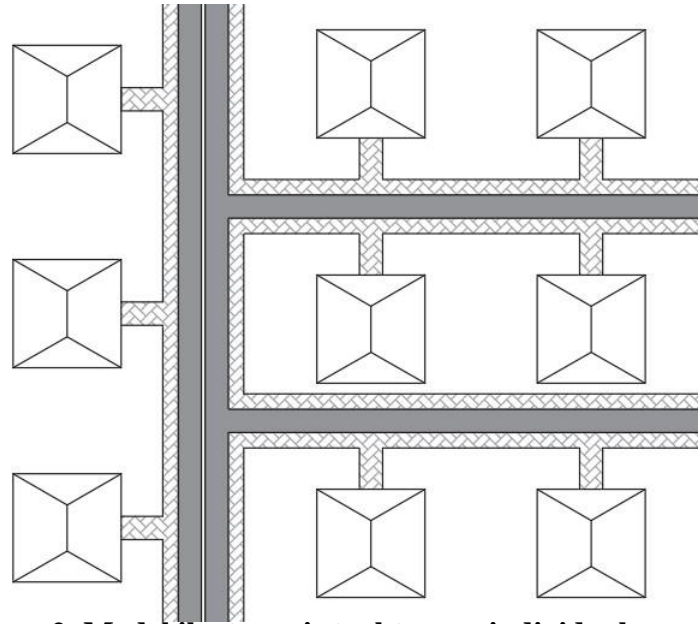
Model ilustrues i strukturave individuale (vila) të grupuara
